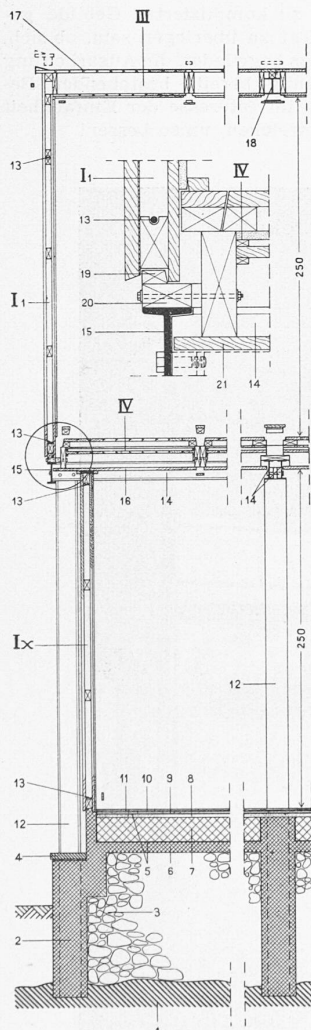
Vertikalschnitt 1:50, 1:10, grösseres Haus. 2, 6 Eisenbeton, 5 Isolation, 7 Schlackenbeton, 8 bis 11 Glattnstrich, Unterlagsboden und Linol, 12 bis 15, 18 Stahlglieder, 16, 19 bis 21 Holz, 17 Dachpappe
